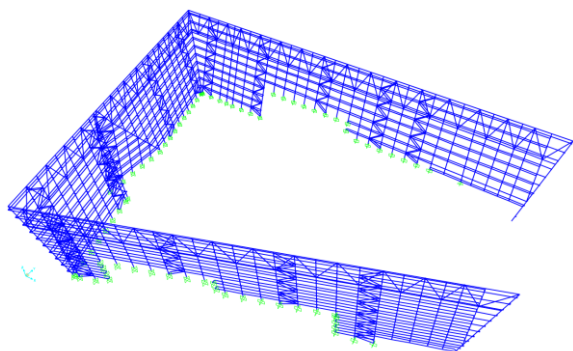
Modelo de cálculo del edificio, aislando la fachada
